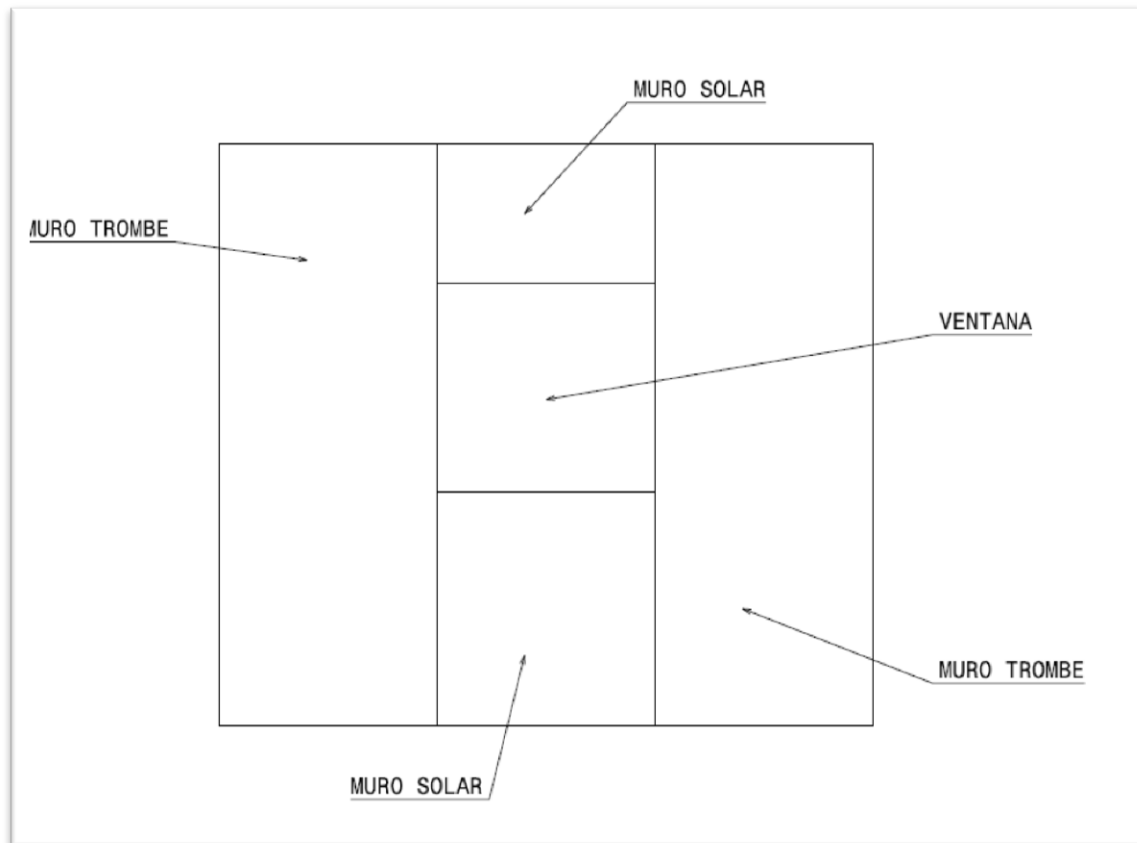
Disposición de muros Trombe y solar en fachada sur.
